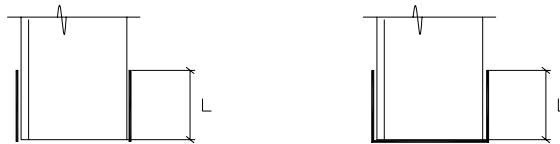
Definição do comprimento de uma barra com ligação soldada.
